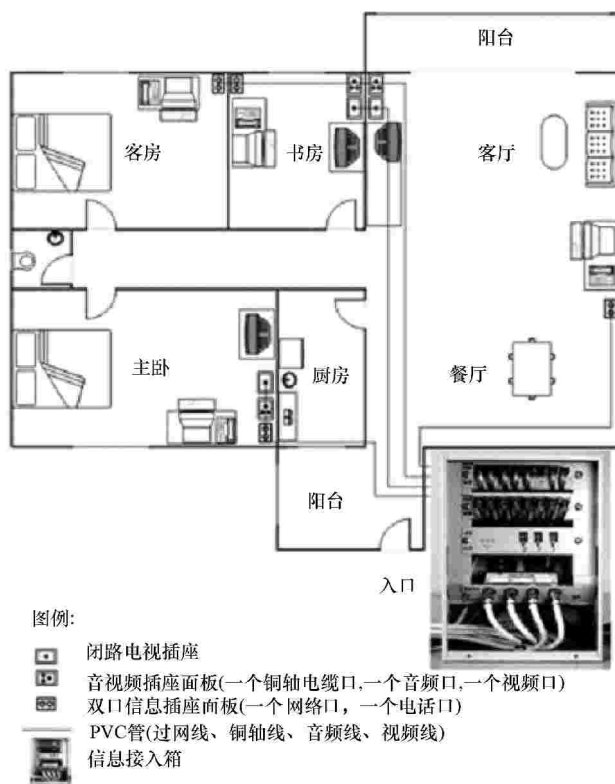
普通的 3 室 2 厅家居住宅综合布线平面图
